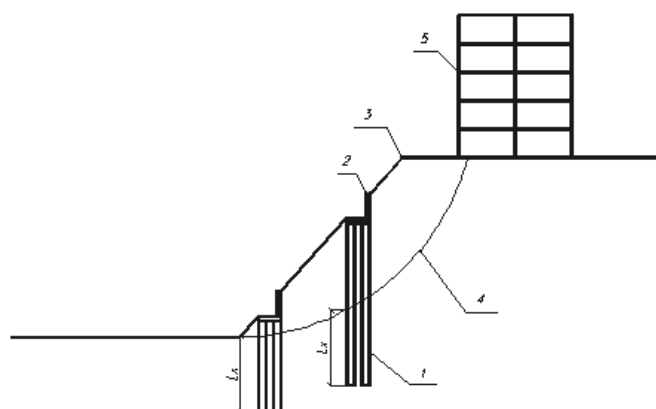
Схема к расчету буронабивных свай противооползневого сооружения
